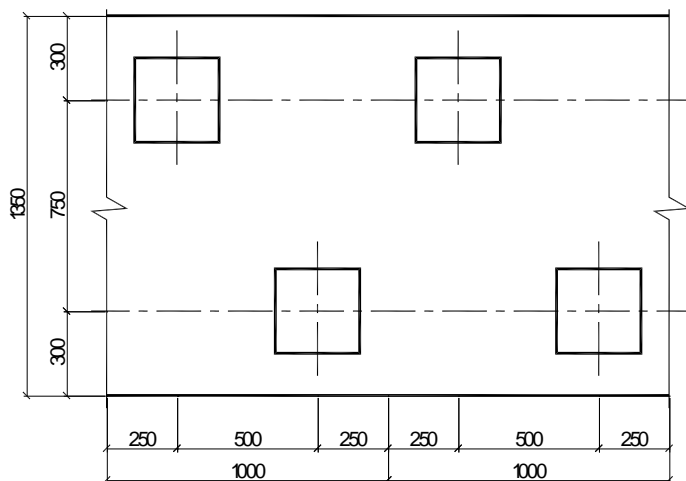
Схема расположения свай в ростверке 12-этажной секции
